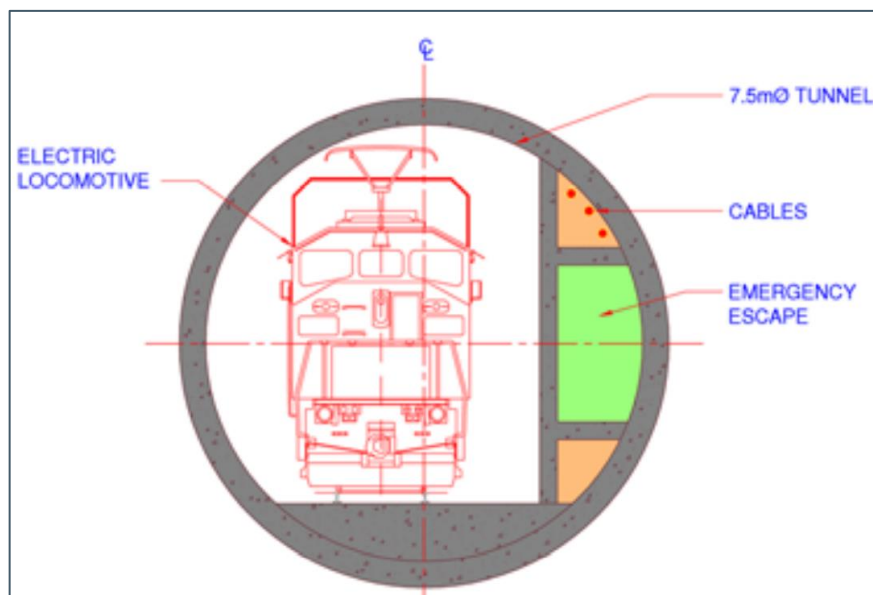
Storebælt – Boret tunnel tværsnit TBM
